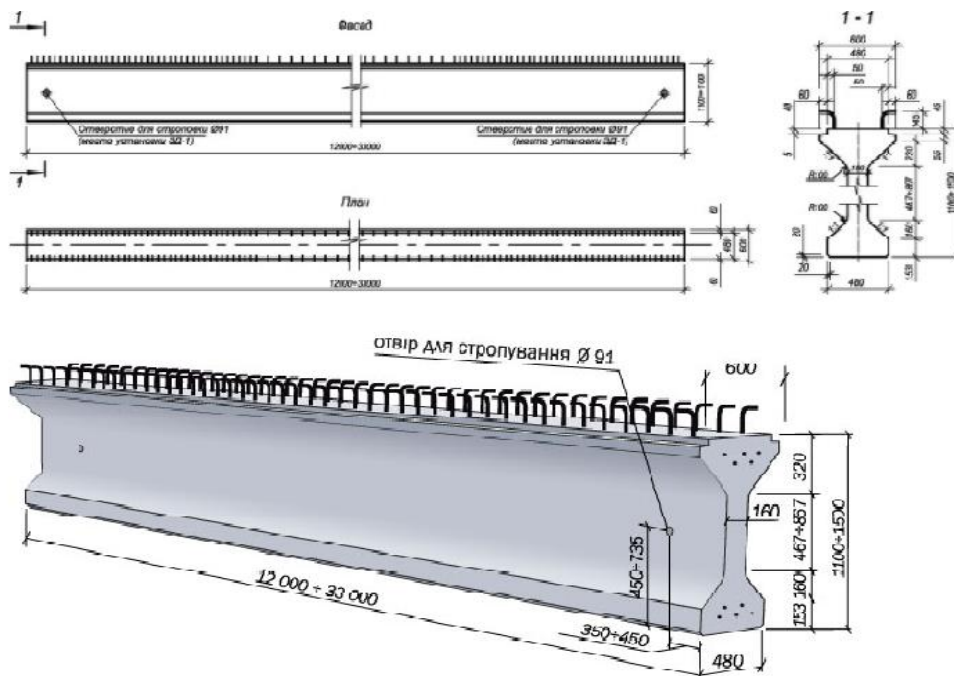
Попередньо напружена залізобетонна балка
